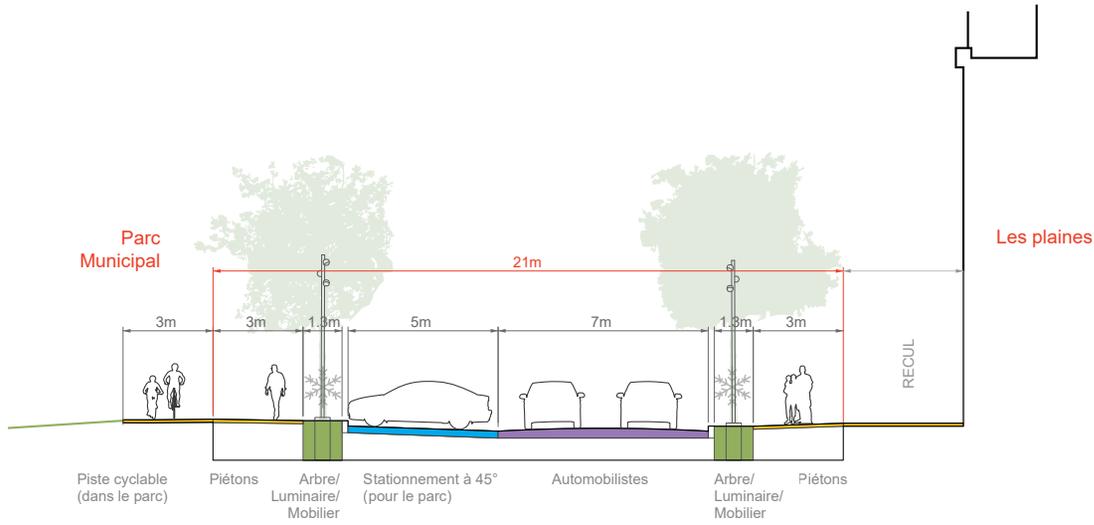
| Place Vimy (21 m) (entre la rue Wellington et le secteur des aqueducs)
